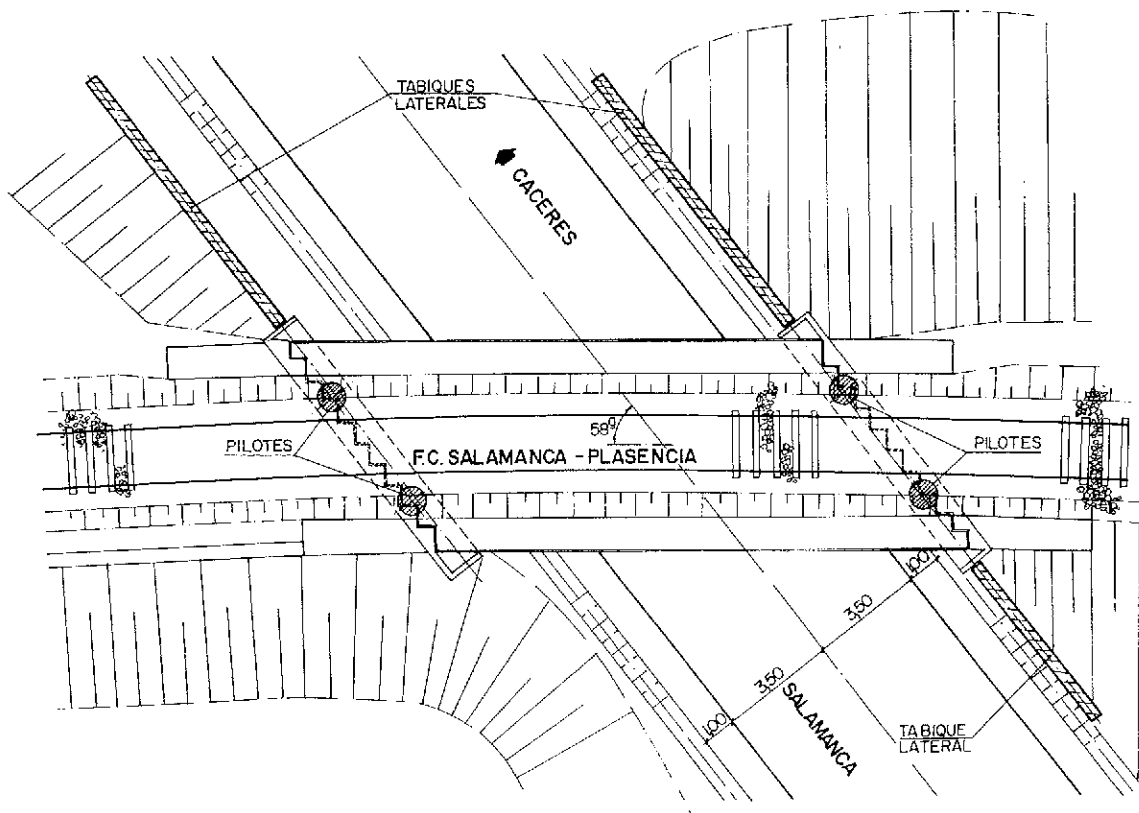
Puente de F.C. sobre la Carretera N-630, en Béjar. Planta general.
